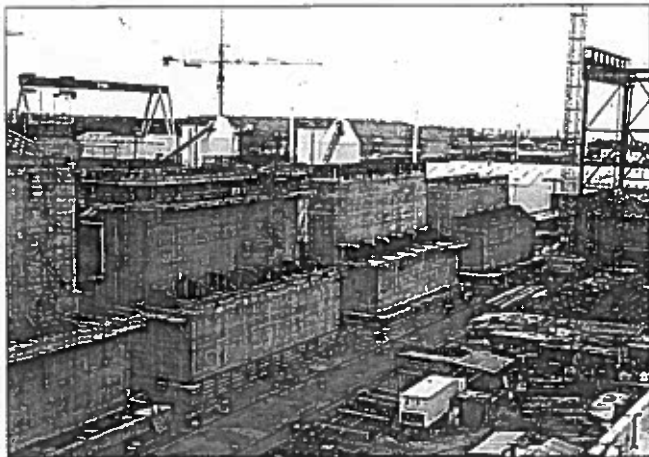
Fertiggestellte Caissons mit Gleitgerüst am Bildrand rechts
